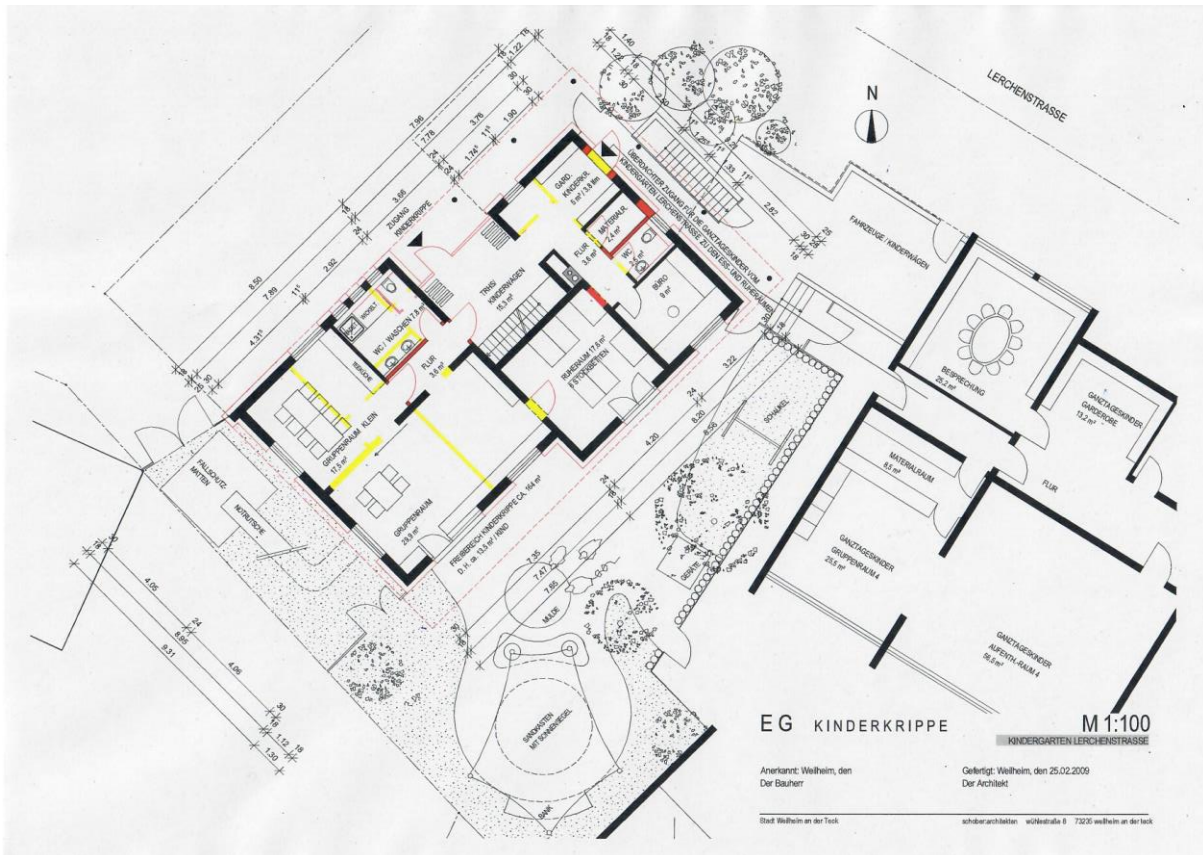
Grundriss der Außenanlage Krippe
